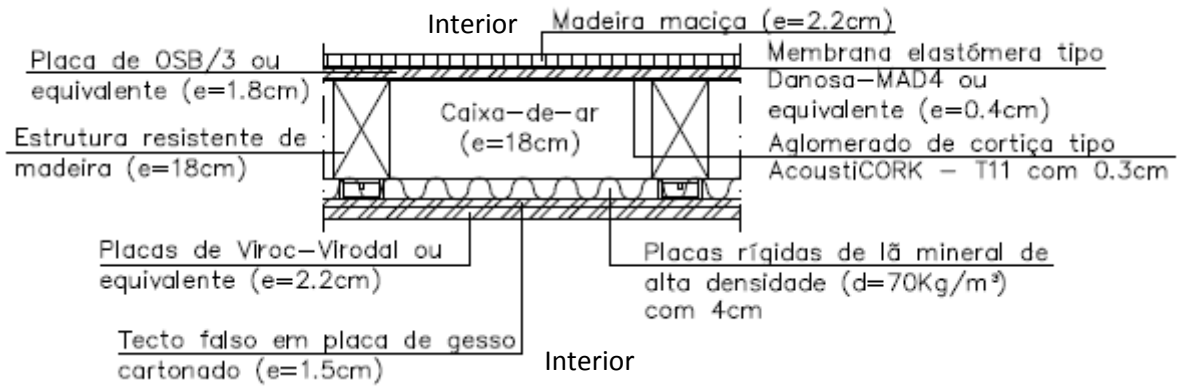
Pormenor construtivo do pavimento 3 [19]
